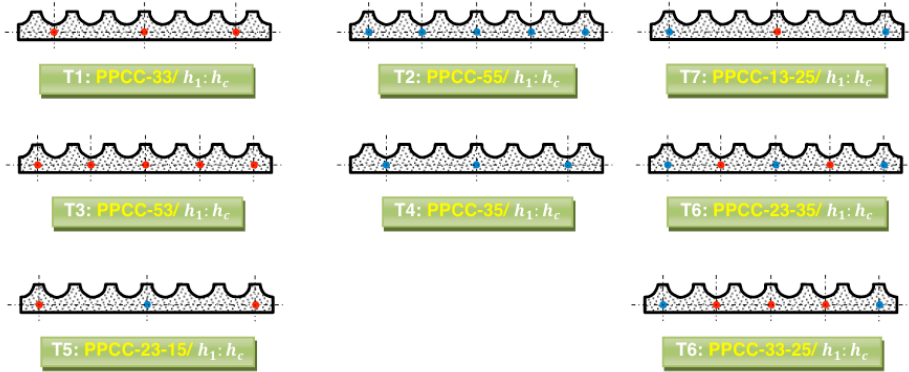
Tipologías de Refuerzo de la Prelosa PPCC
